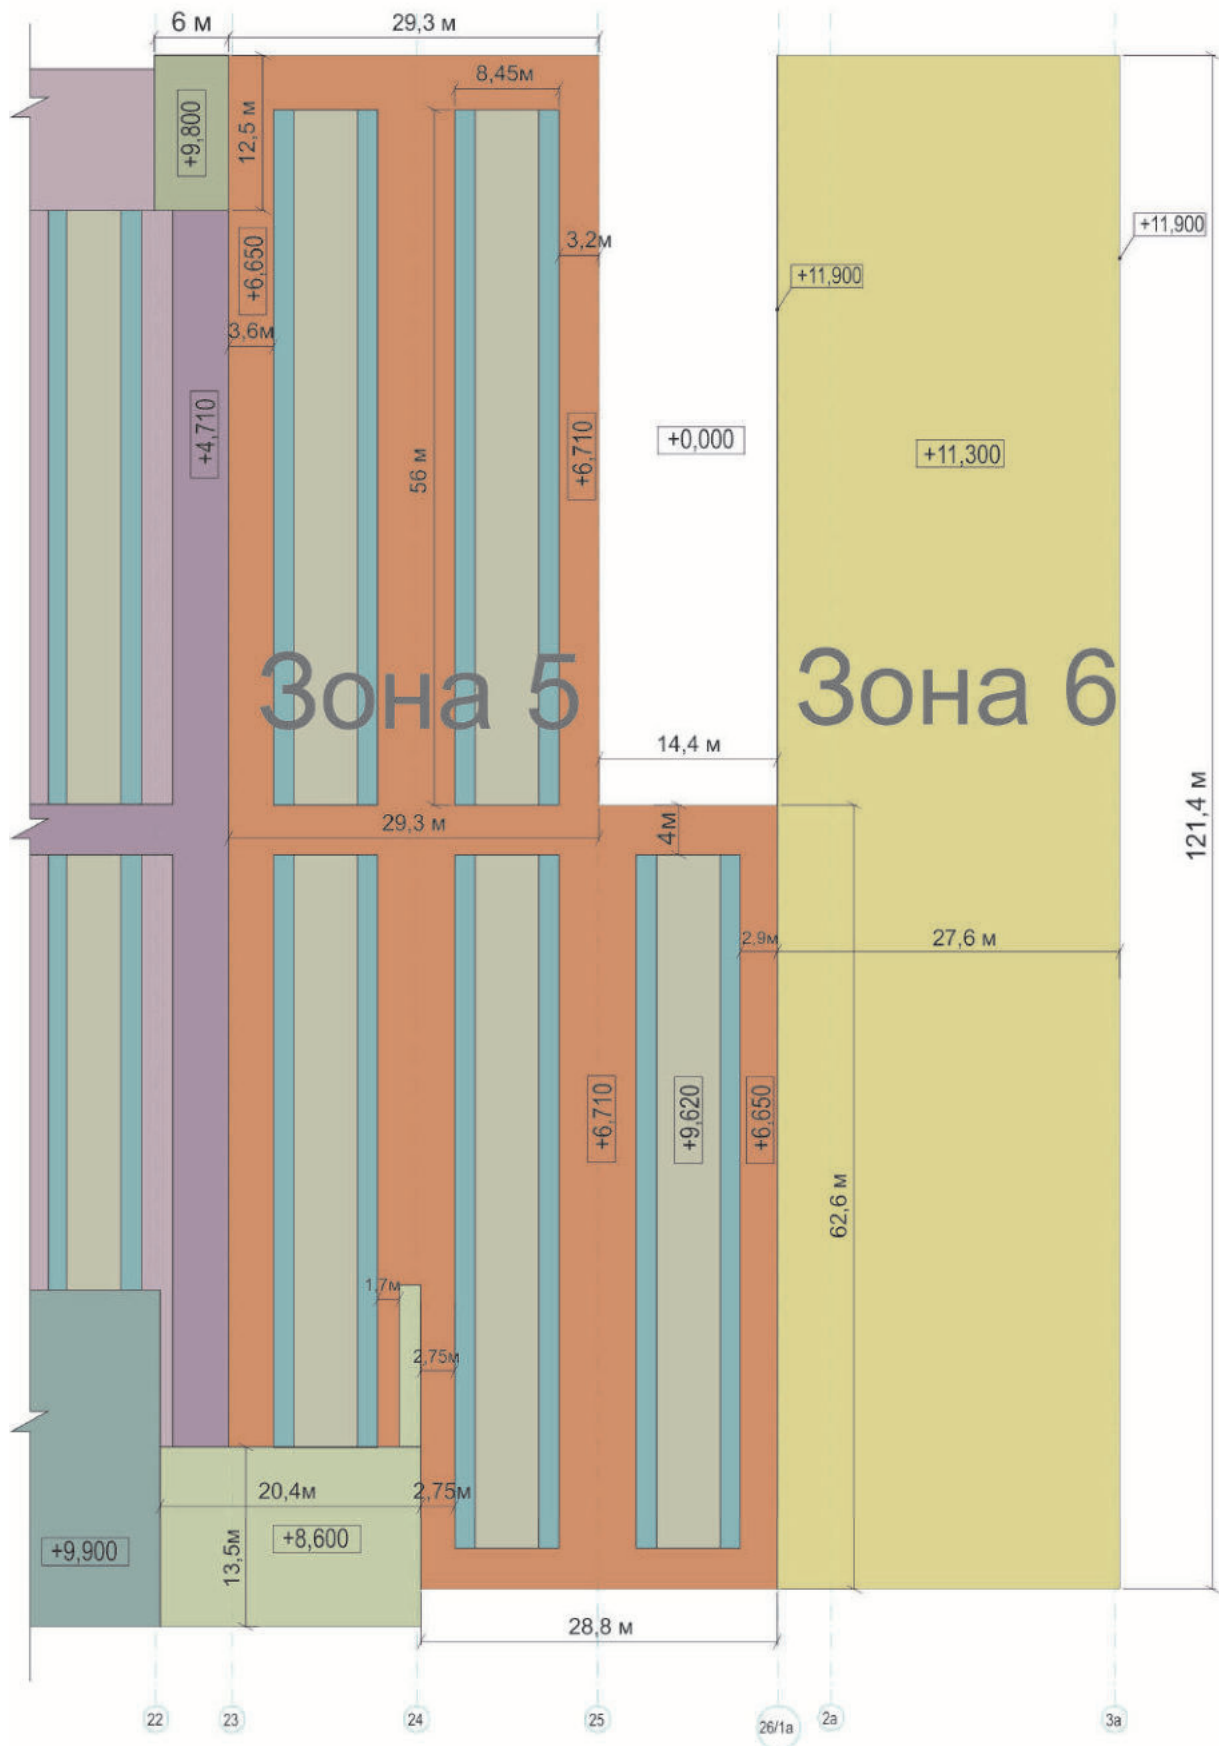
Фрагмент плана покрытия корпуса №5. 2-ой вариант покрытия
